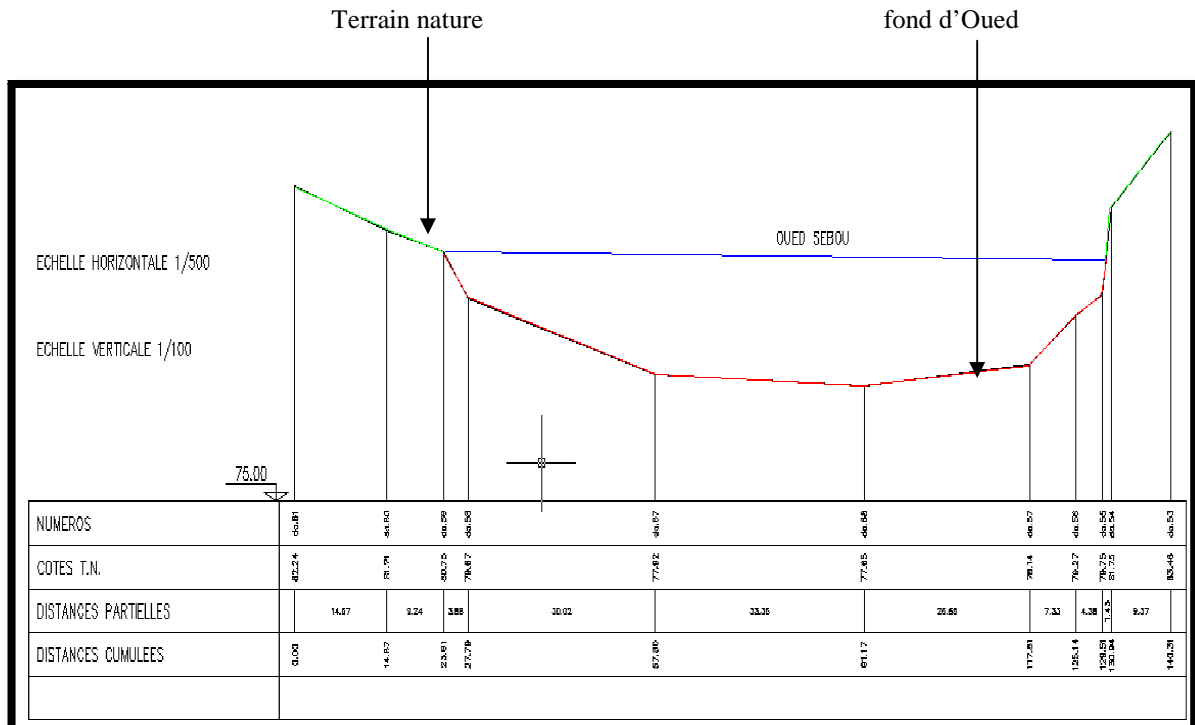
Le profil en travers de la coupe 5 d'Oued Sebou
